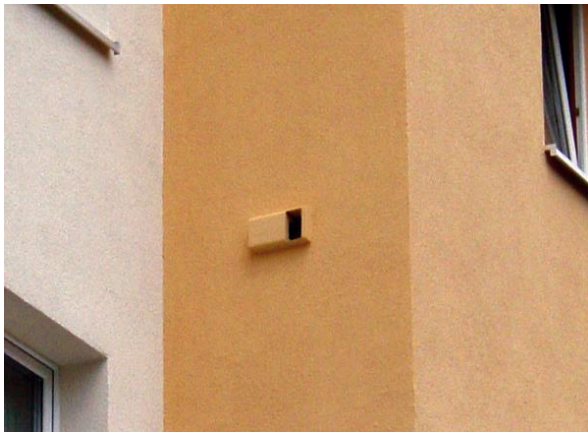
Fassaden-Einbaukasten 1HE, Einbaubeispiel Fassade (Quelle: www.schwegler-natur.de)
